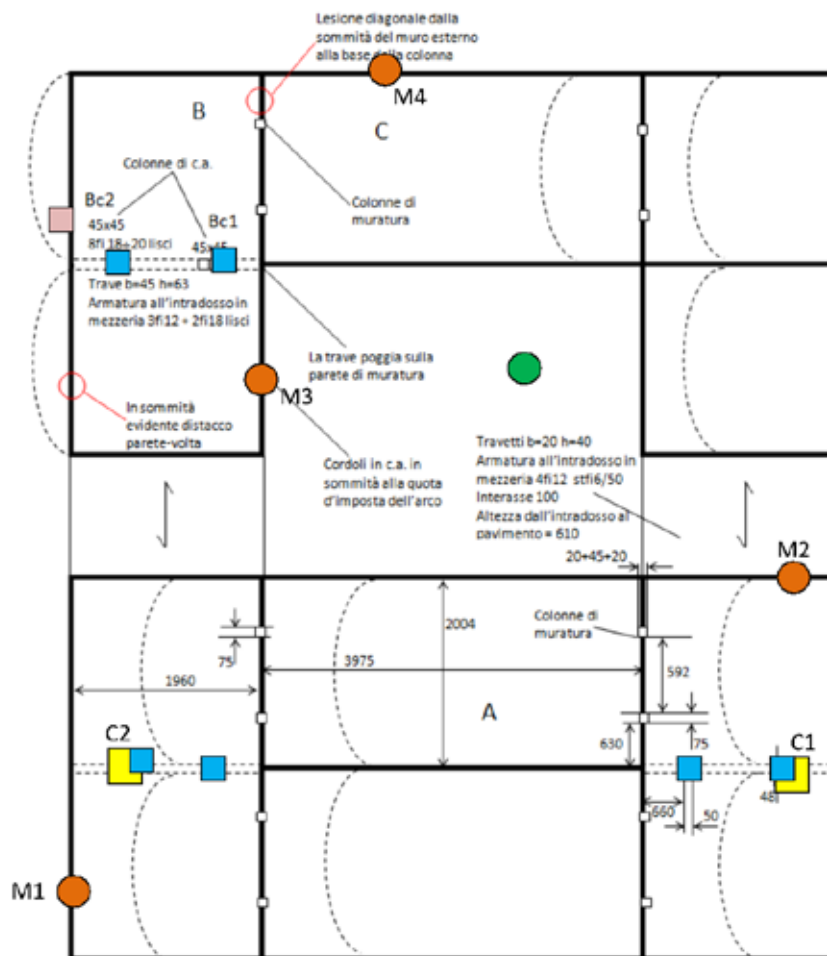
Planimetria delle indagini effettuate da Geotecnica s.r.l. su murature ed elementi in c.a..
